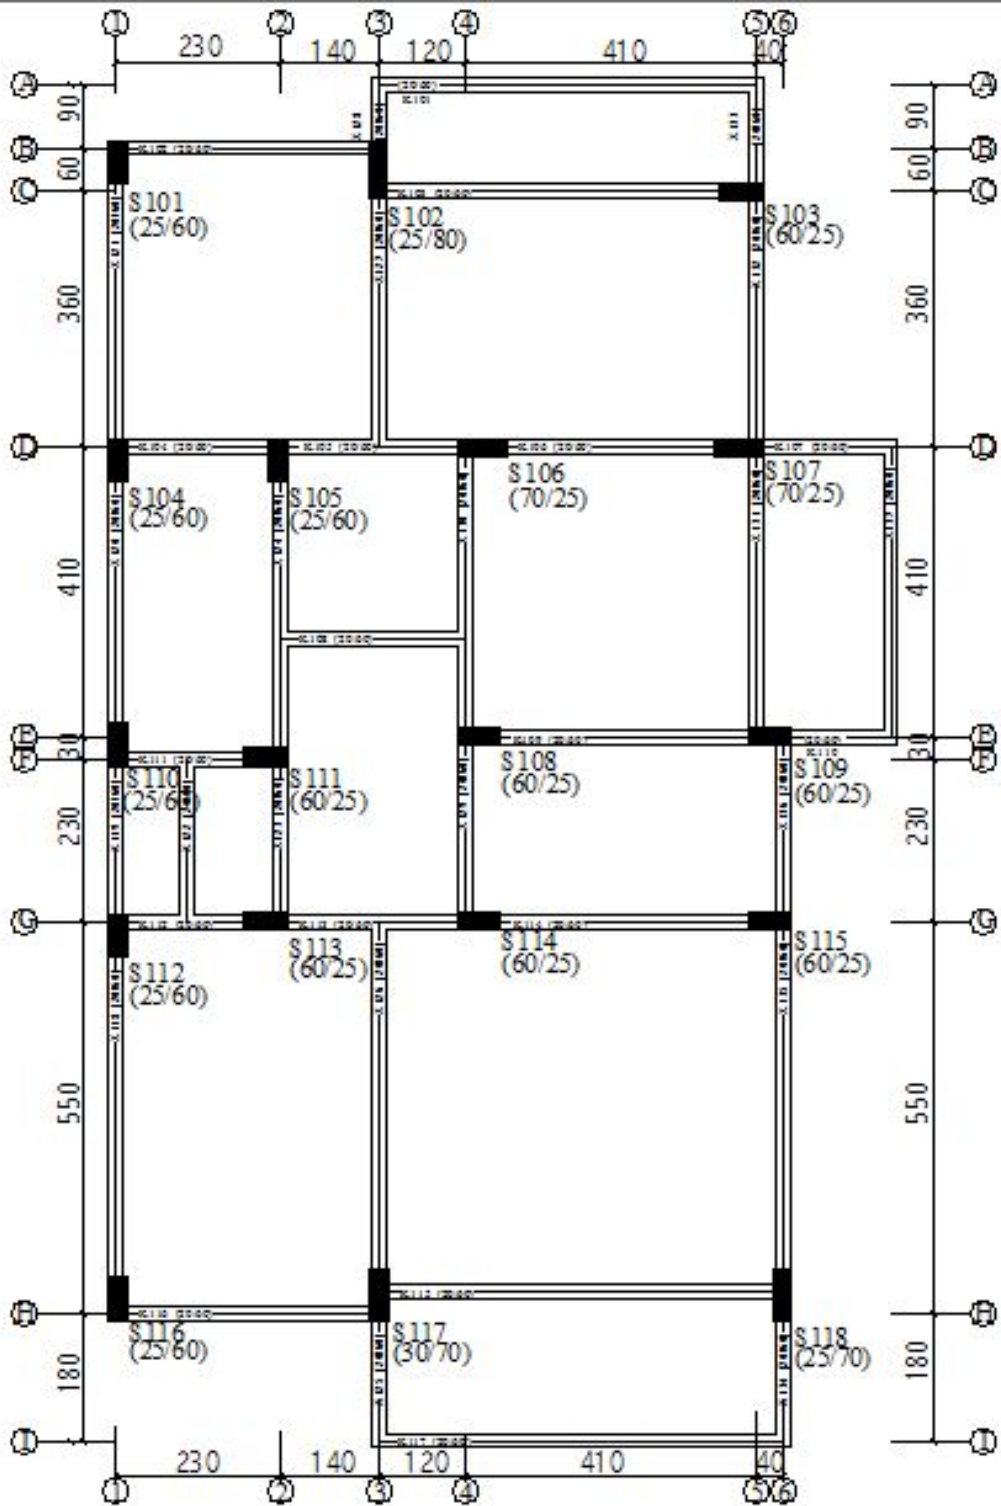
4K-B10 nolu binanın kalıp planı
